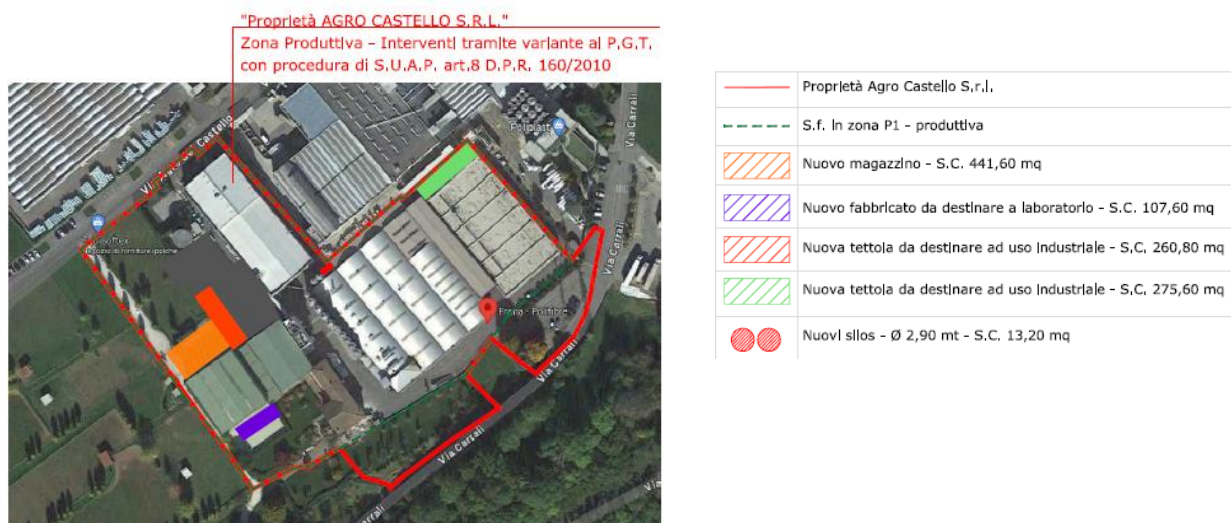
Estratto ortofoto – scala 1:2000 (fonte allegato 009).
